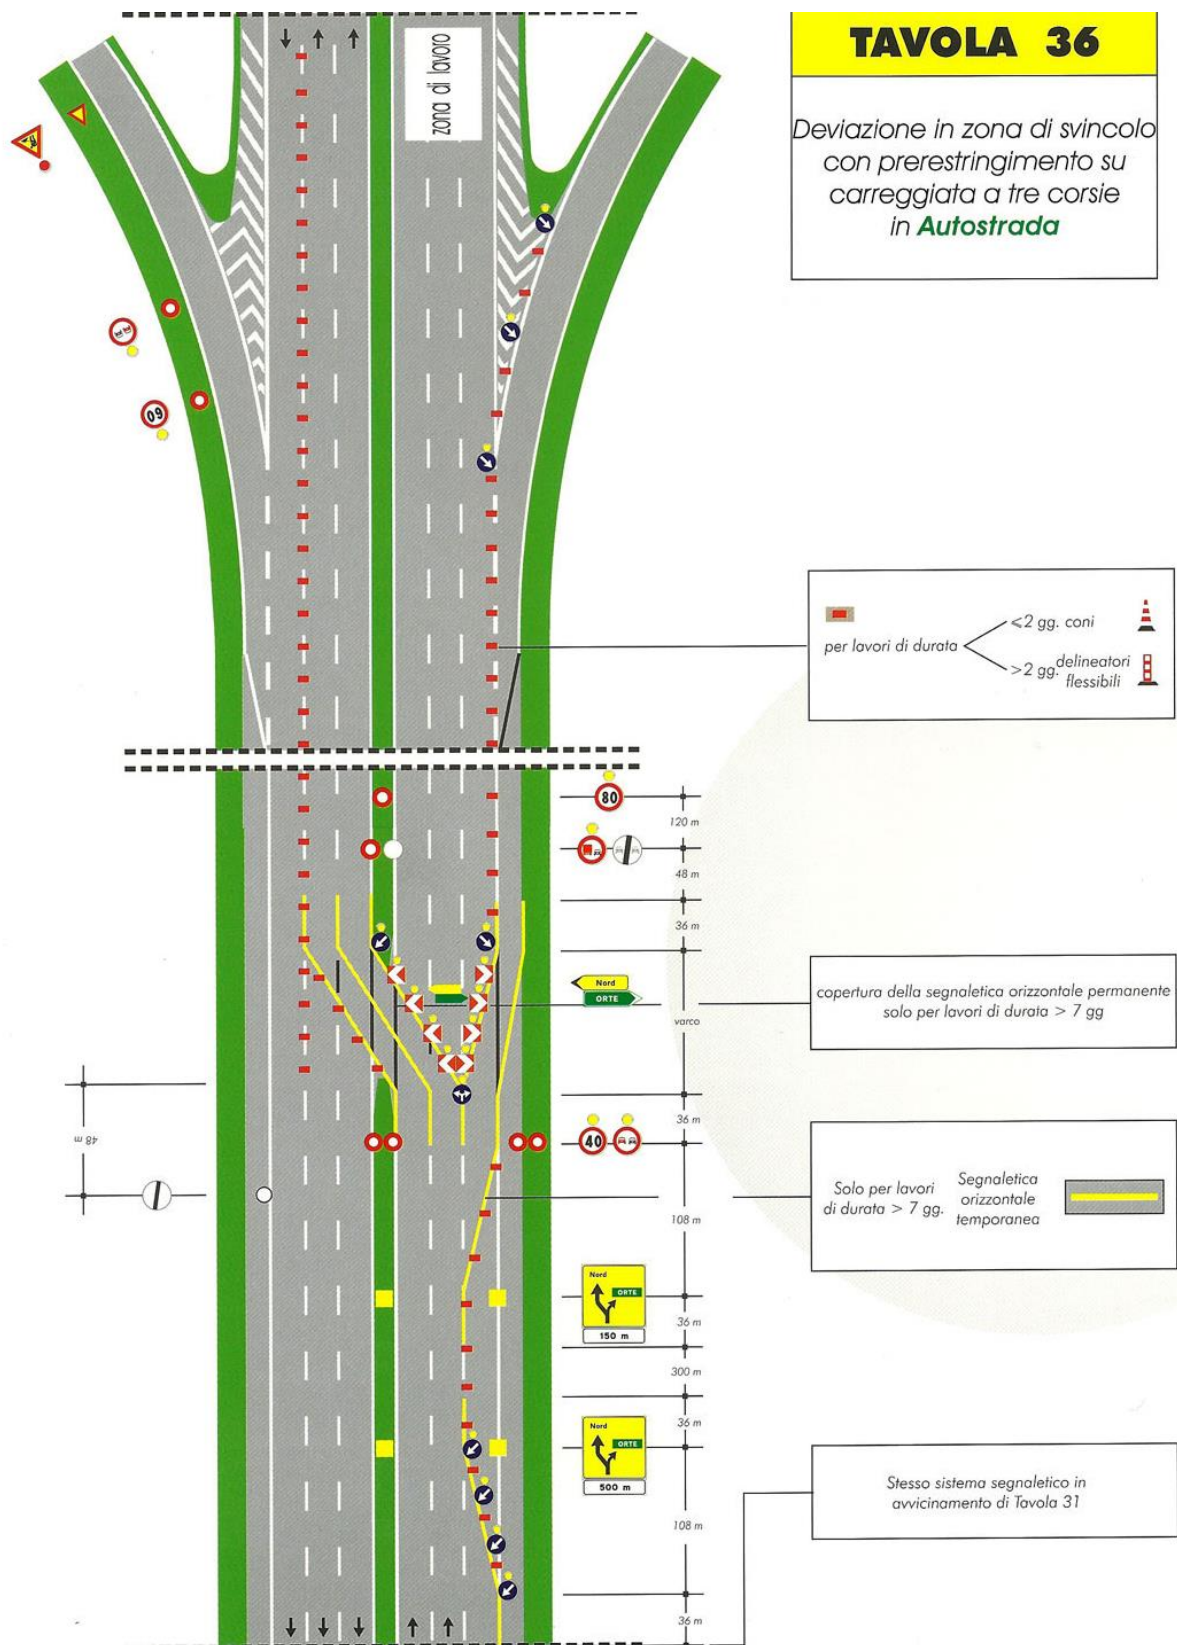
Schema segnaletico Tav.36 rap.deviazione in zona di svincolo con restringimento
